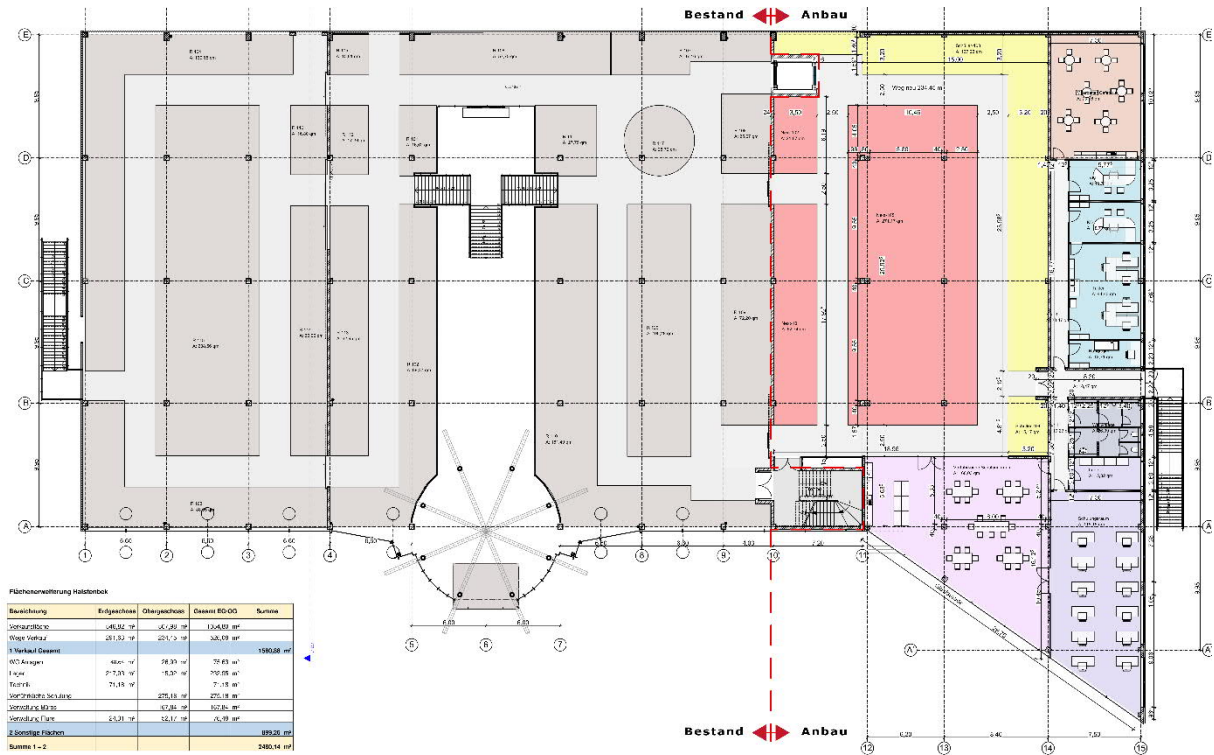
Grundriss 1.0G mit Erweiterung rechts
